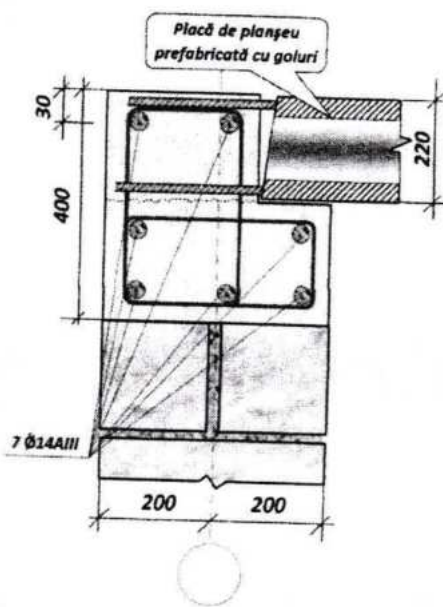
Scheme constructive a fundației continue, pereților structurali și planșeului
